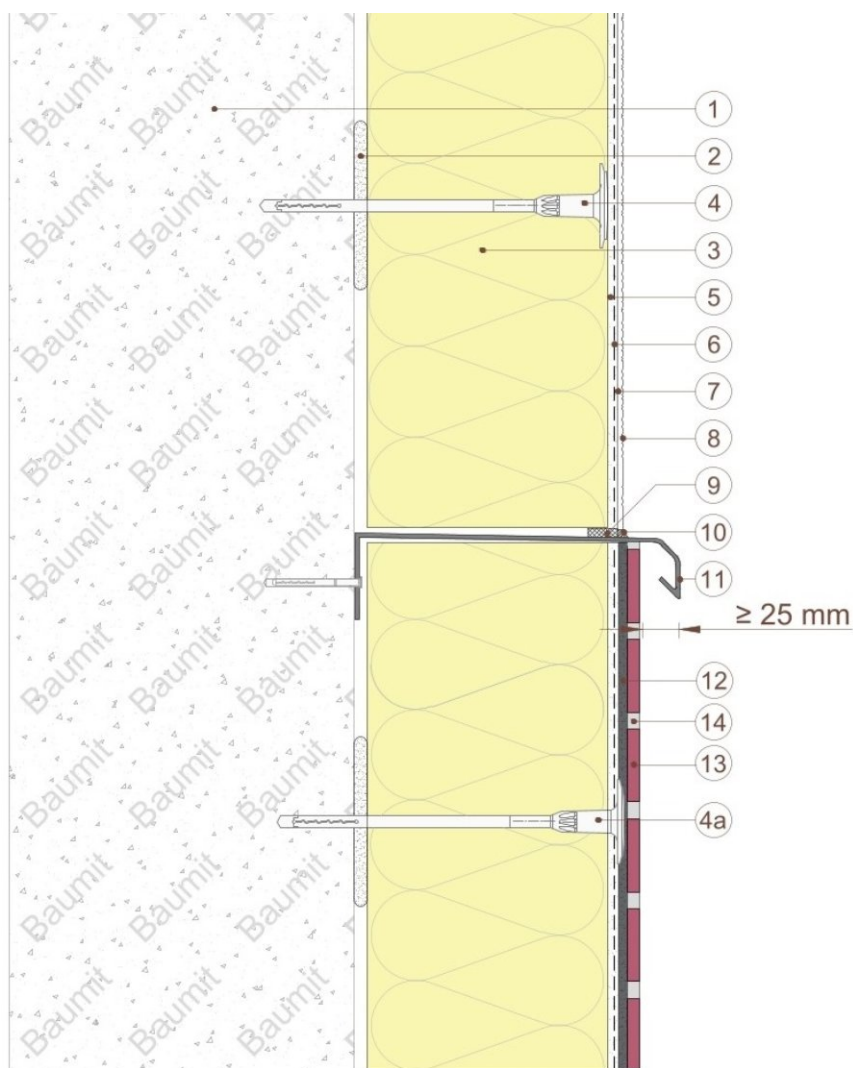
Système Baunit StarSystem Mineral avec finition par plaquettes en terre cuite - Détail de la mise en œuvre d'un joint de fractionnement par profilé
